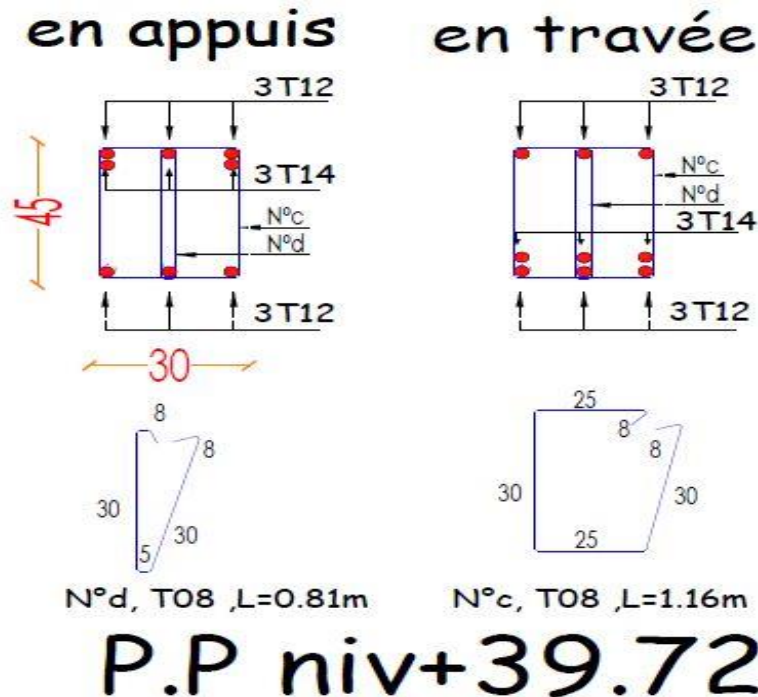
ferrailage du poutre principale niveau +39.72
